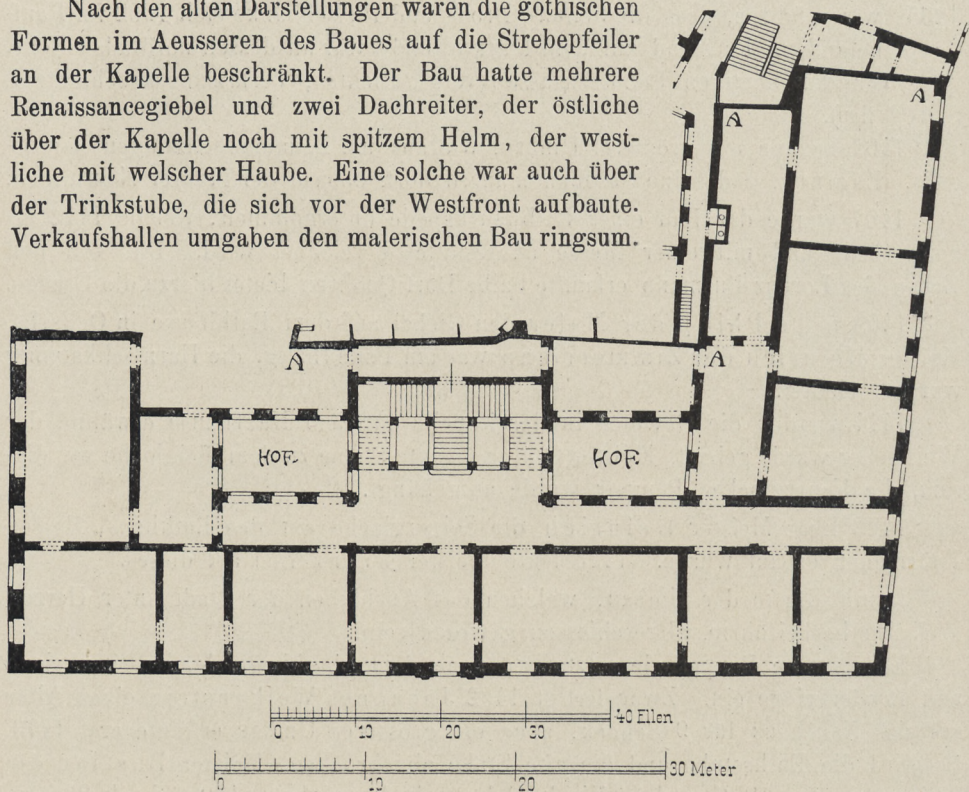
Das ältere Gewandhaus; Grundriss des Obergeschosses.
